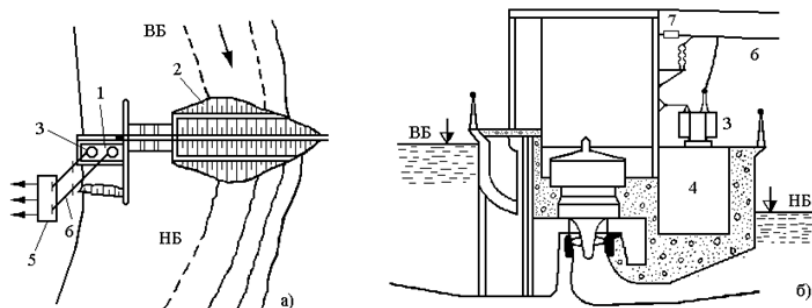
План (а) і поперечний переріз (б) ГЕС, розташованої на руслі.
